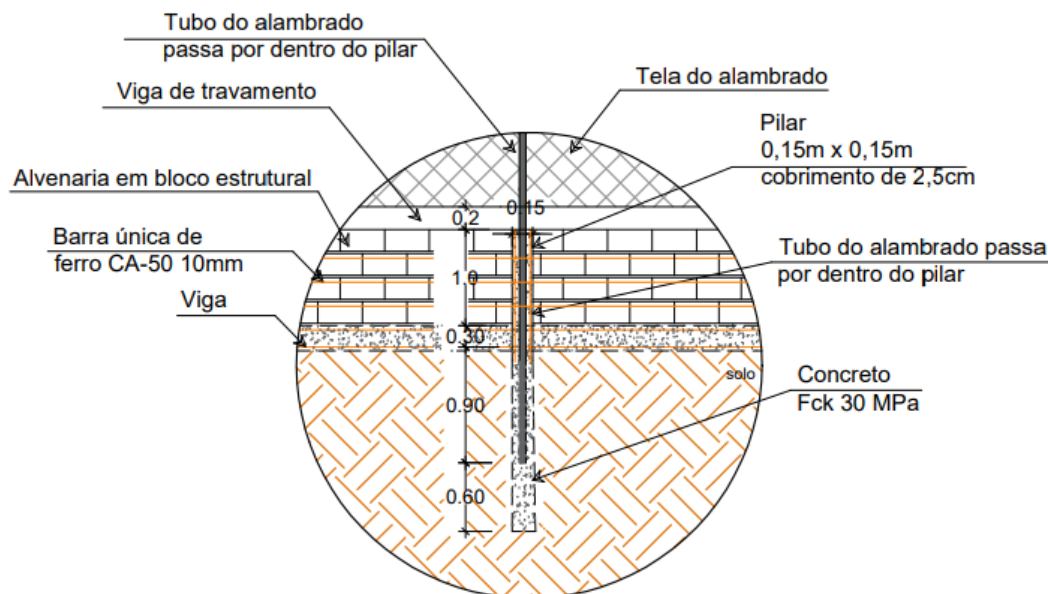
Detalhe dos blocos estruturais (Fonte: Autor/2024)
